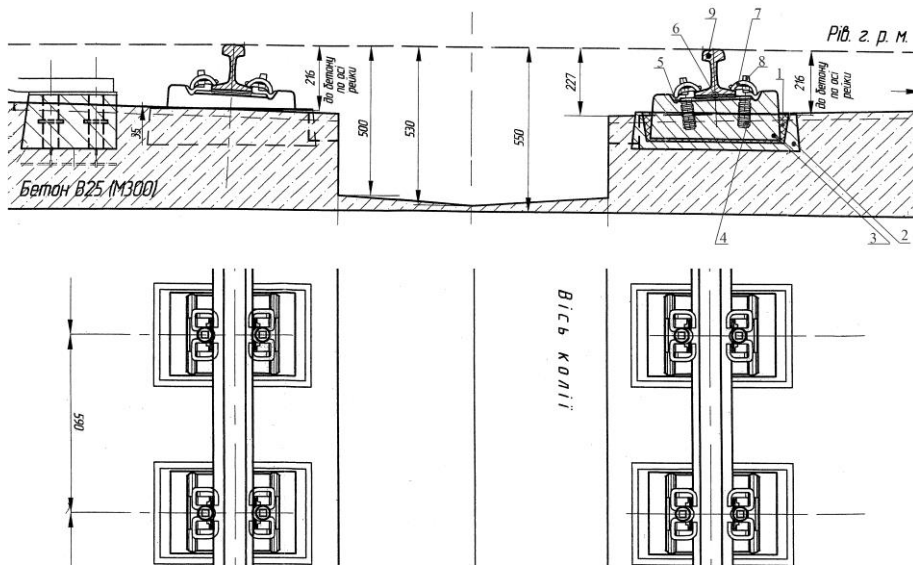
Ізольований рейковий опорний блок – варіант зі збірним бетонним лотком: 1 – ізоляція опорного блоку; 2 – збірний лоток опорного блоку; 3 – збірний бетонний опорний блок; 4 – гвинтовий дюбель; 5 – кутова напрямна; 6 – підрейкова прокладка; 7 – пружна клема SKL-21; 8 – гвинт; 9 – рейка
